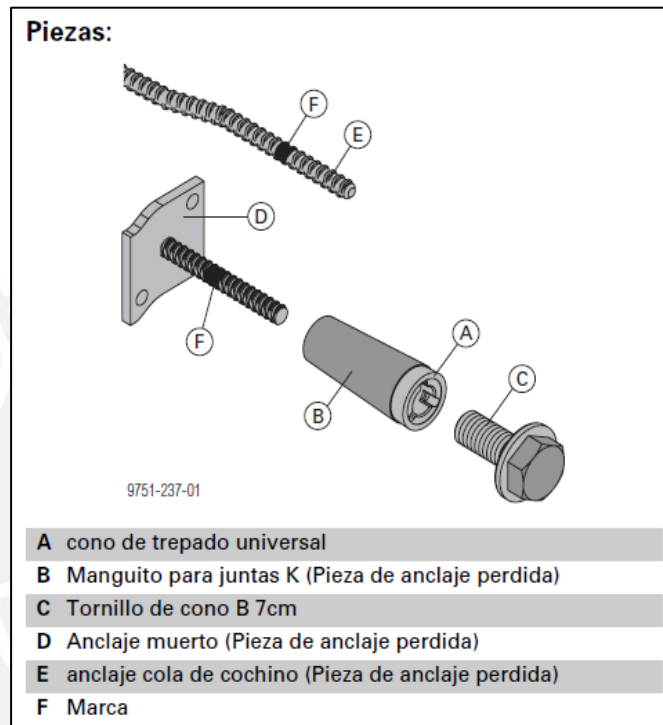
37 Piezas de anclaje del Sistema Autotrepante ATR. (Doka Perú SAC, 2008)
